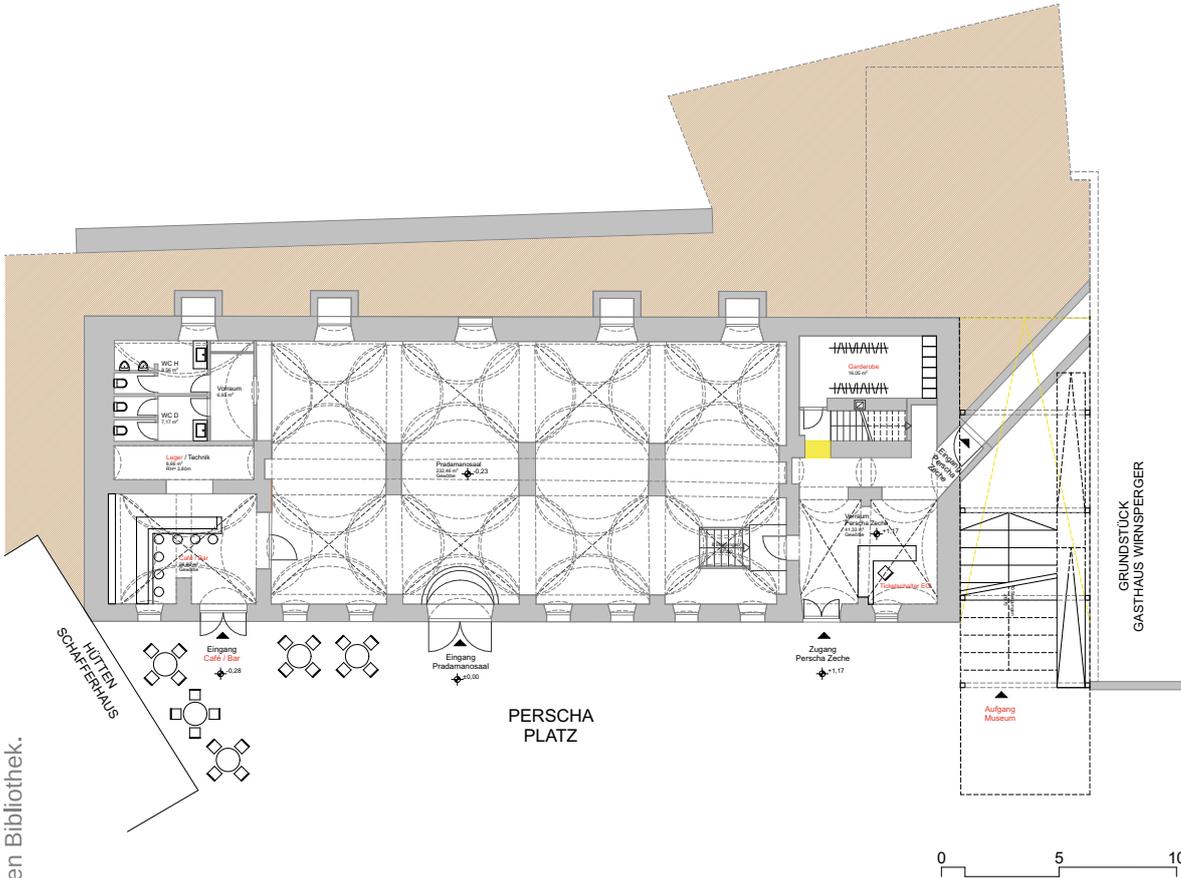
Entwurfsplan Erdgeschoss Antoni Grubenhaus
